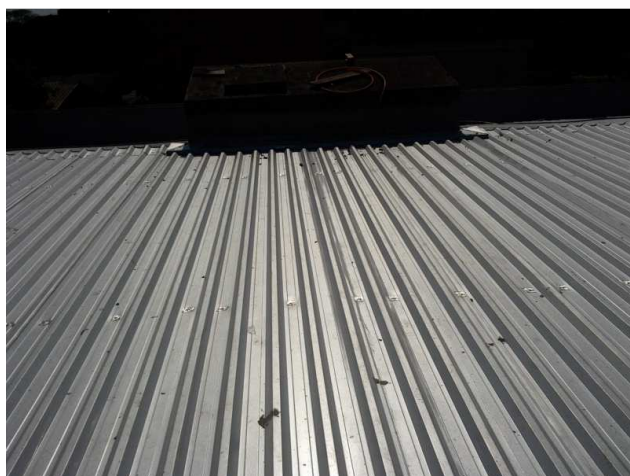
C: Telha metálica trapezoidal tipo sanduíche, com injeção de poliuretano
